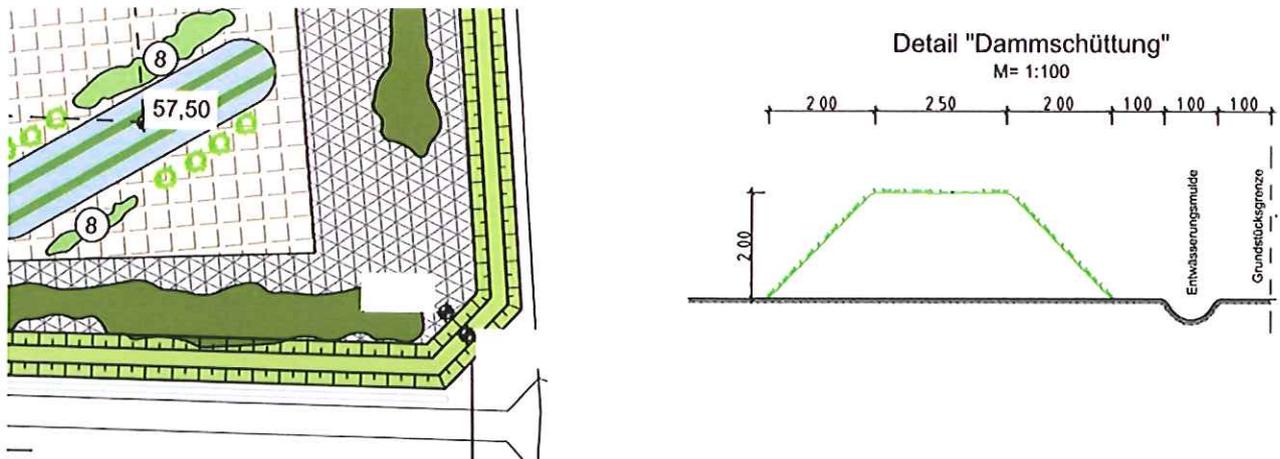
Erdwalleinfassung (Quelle BFT Planung)
